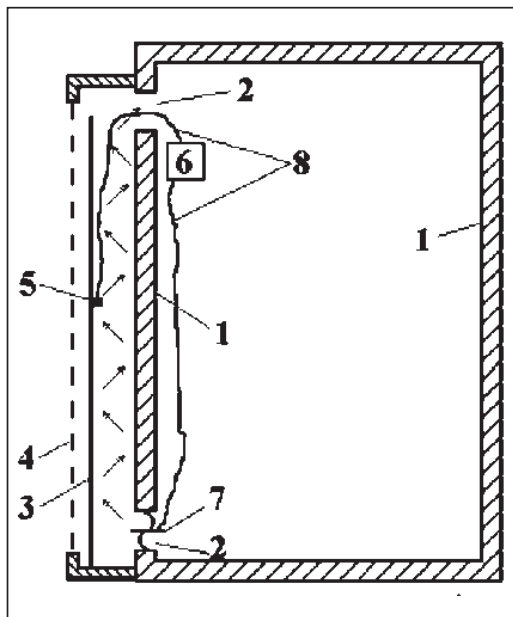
Принципова технологічна схема автоматичного регулювання пасивної системи сонячного опалення (на основі стіни Тромба): 1 — масивна стіна приміщення; 2 — циліндричний отвір в стіні; 3 — світлопоглинаюча металева пластина; 4 — скло; 5 — термопара для визначення температури металевої поверхні; 6 — терморегулятор; 7 — вентилятор для нагнітання повітря з приміщення в простір між металевою пластинкою та стіною приміщення; 8 — з'єднувальні дроти
